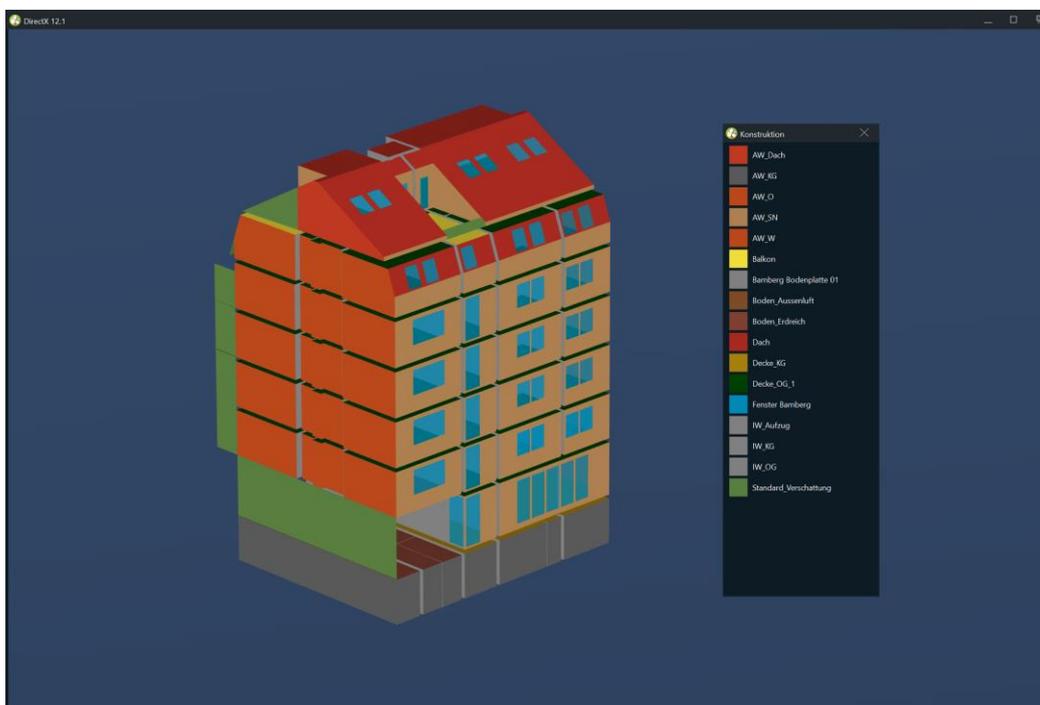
Detailliertes Gebäudemodell Straßenansicht Konstruktionsansicht Variante 3
